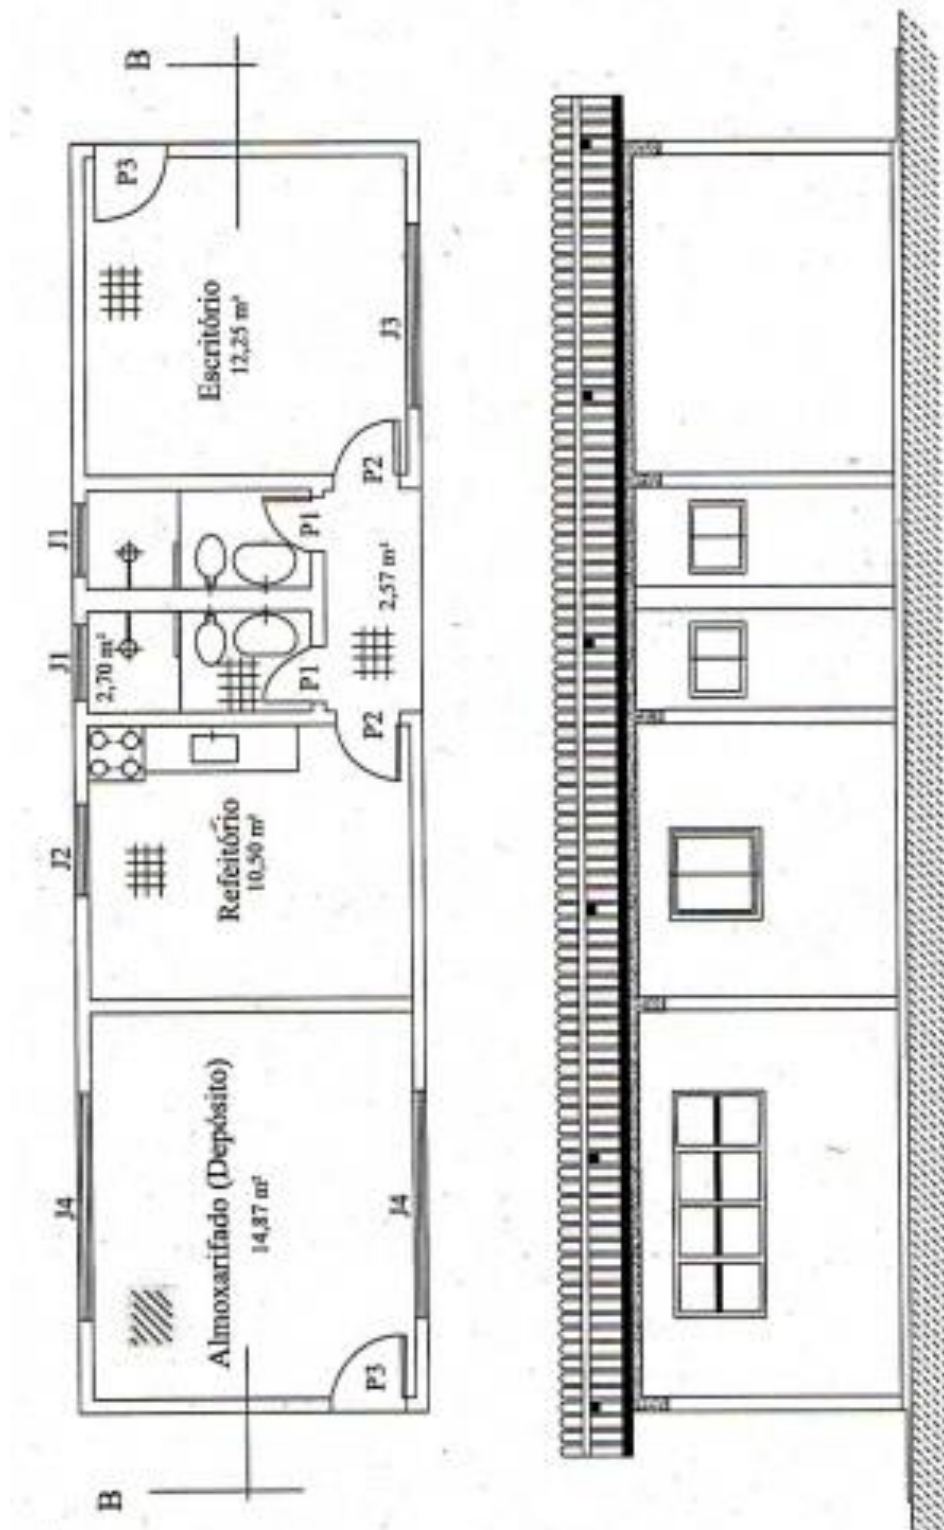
Planta Baixa do Galpão de Recepção e Triagem.
